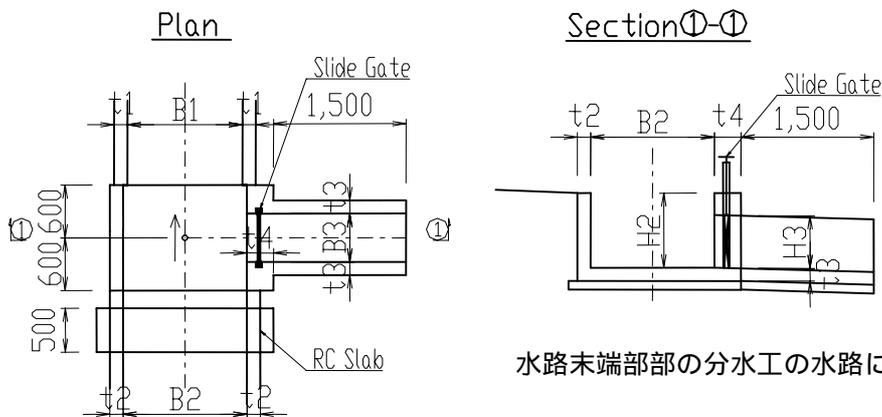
上流側分水工 (パイプ使用)
